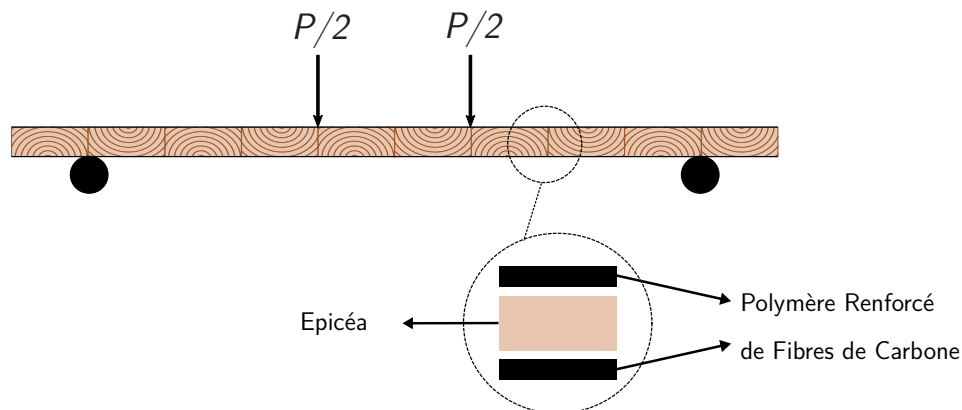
Essai de flexion 4-points sur une poutre sandwichs (Perret et al., 2018)
